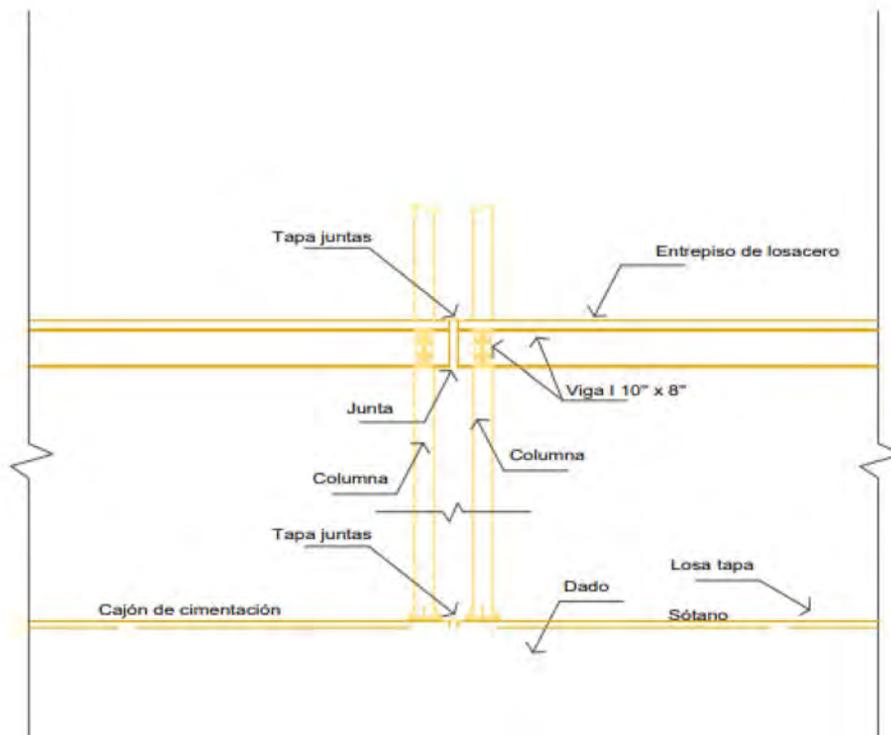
Detalle 04, referido en la losa del Primero, Segundo Pisos.
